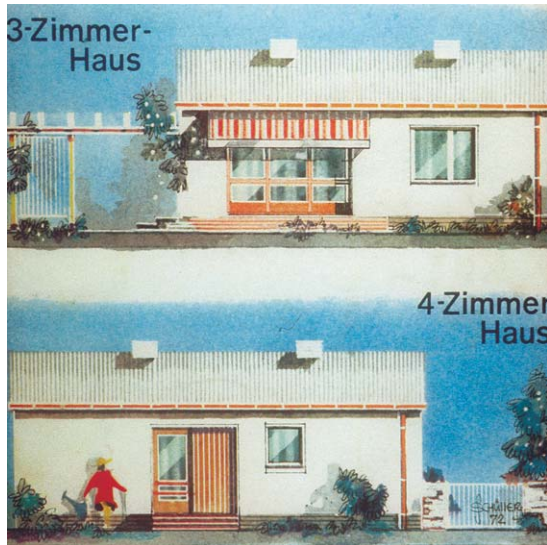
Eingeschossige Holzbeton-Einzelhäuser
